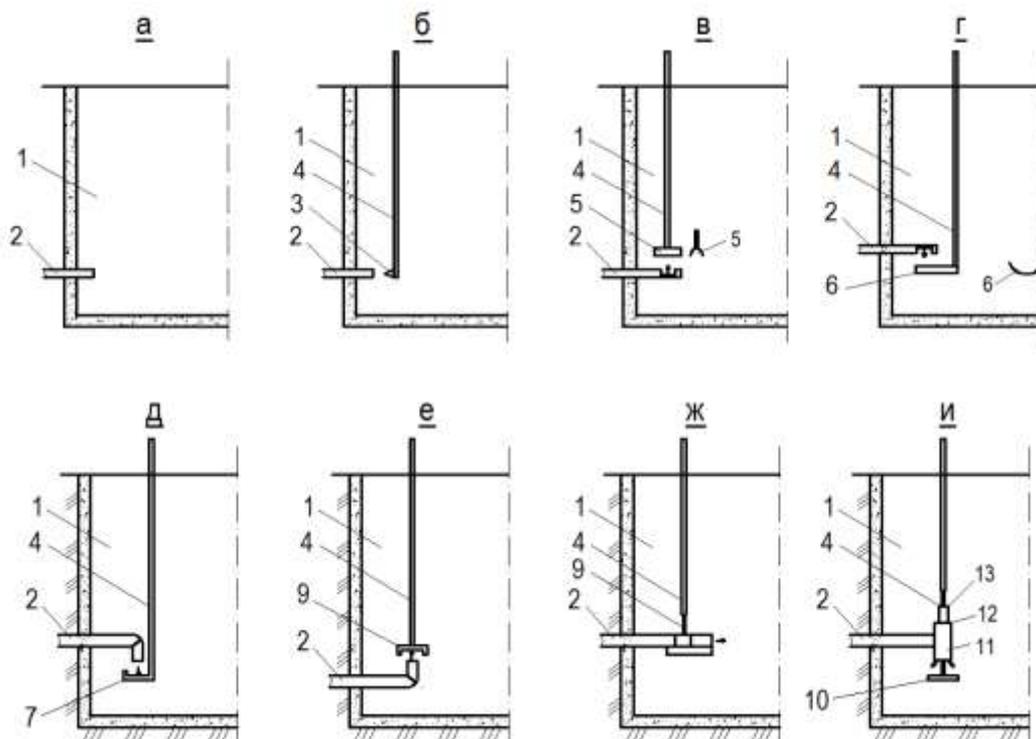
Запорные устройства соединительных труб. 1 – колодец; 2 – труба; 3 – пробка; 4 – стержень (арматура); 5, 6 – полутрубки; 7, 8 – клапаны; 9 – щиток; 10 – клапан; 11 – стакан; 12 – дно стакана; 13 – трубка; 14 – ограничитель.
